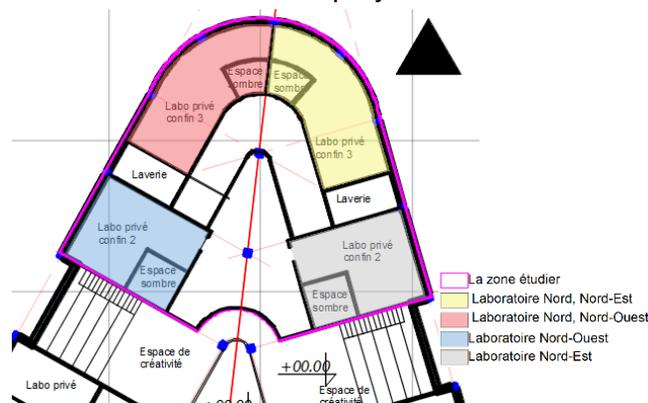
Vue en plan de l'espace étudié niveau +16.32 m. Source : Auteur
